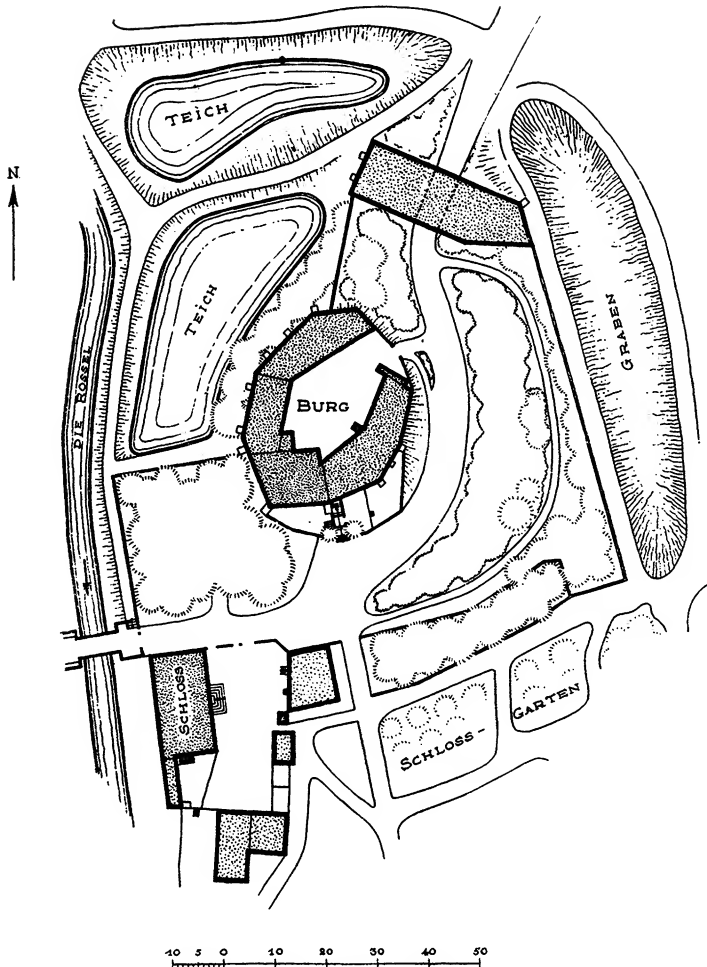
Dessau—Roßlau. Lageplan der Burg
